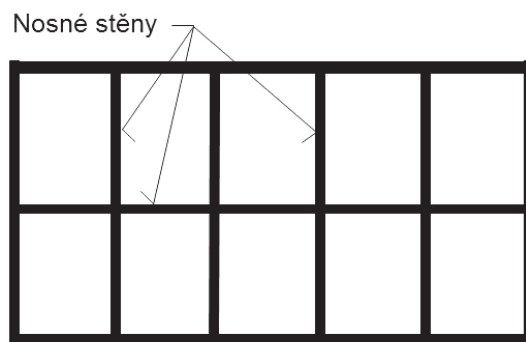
Půdorys – podélný stěnový konstrukční systém
